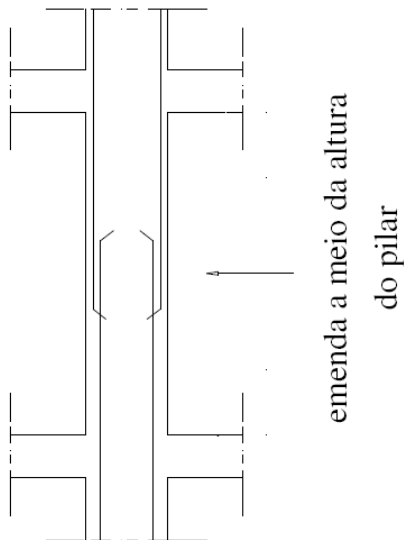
Emenda tipo num pilar (Nova Faceta)
